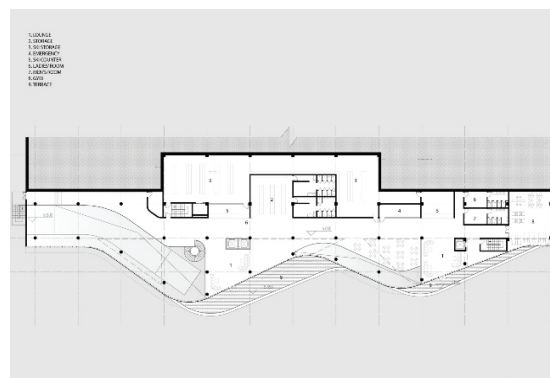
План 2-го этажа БГК «Yunmen Mountain».
